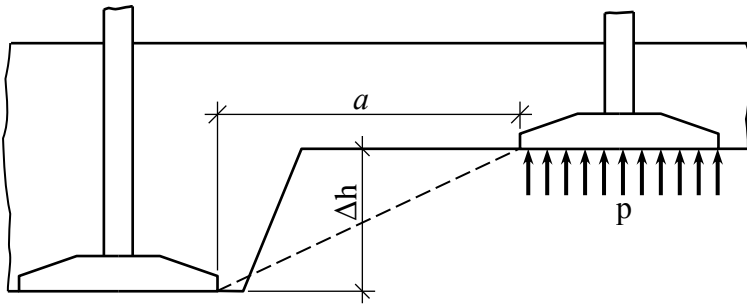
Схема примикання фундаментів, які проектують, до існуючих
